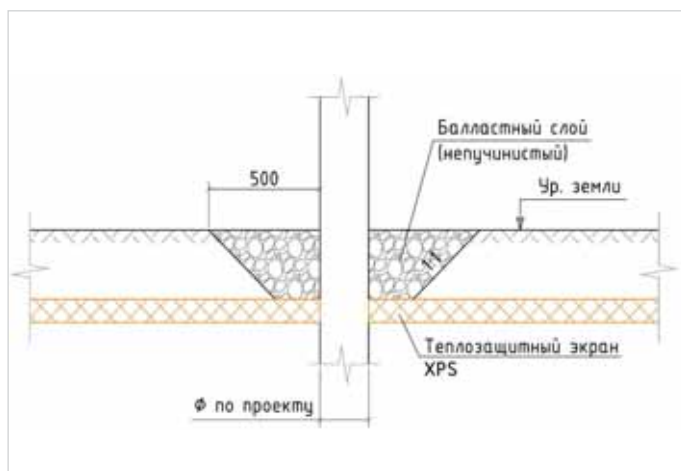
Принципиальная схема устройства теплозащитного экрана из экструзионного пенополистирола у оголовка сваи
